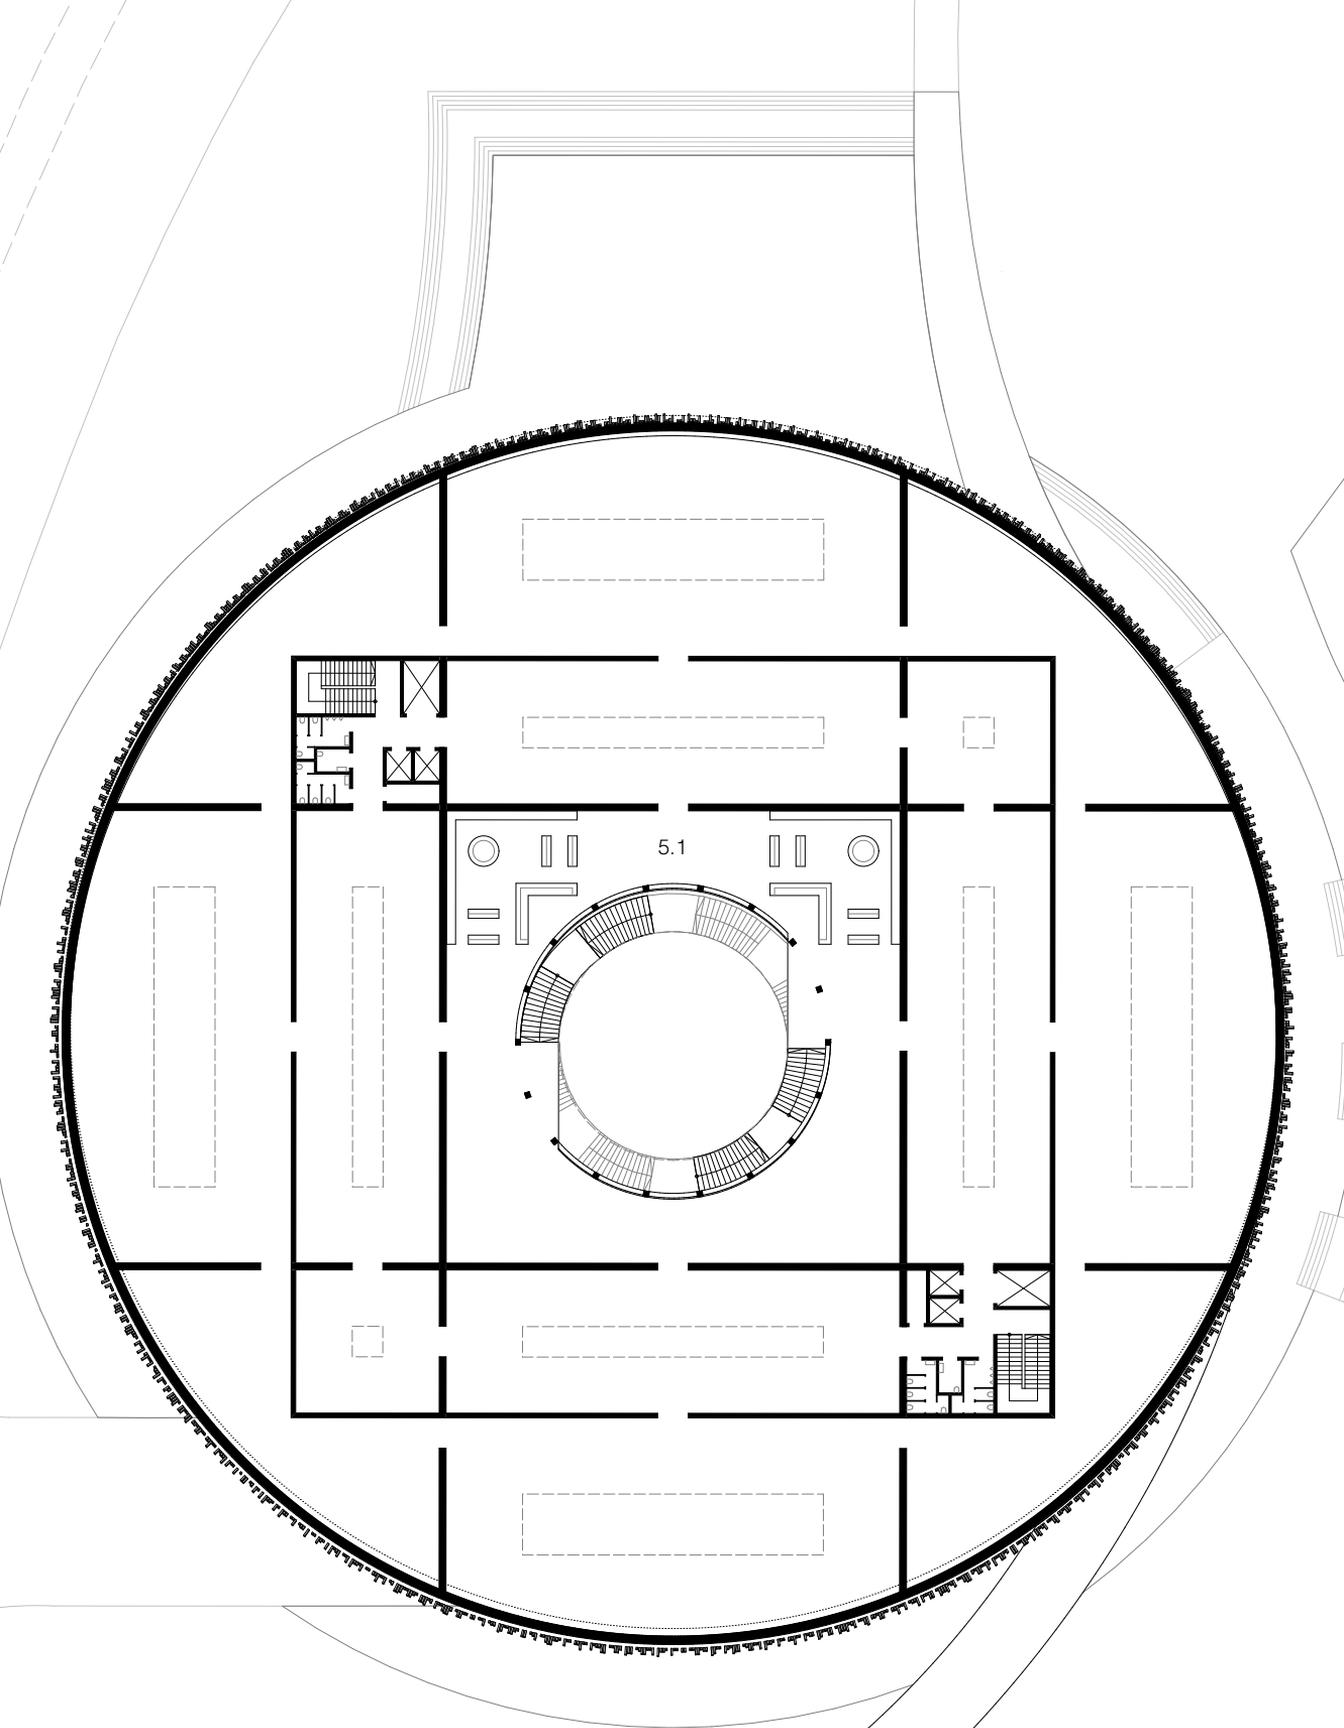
Grundriss 2. Obergeschoss - Ausstellen - M1:500
